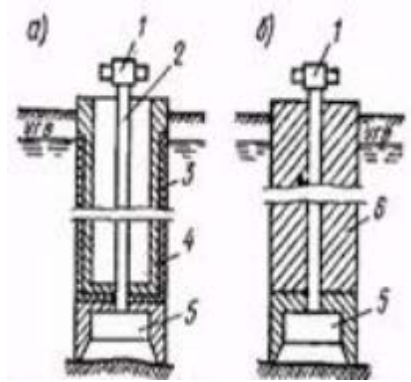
а — для заглибленої будівлі; б — для фундаменту глибокого залягання; 1 — шлюзовий апарат, 2 — шахтна труба, 3 — гідроізоляція, 4 — надкесонна будівля, 5 — кесонна камера, 6 — монолітний масив фундаменту.
